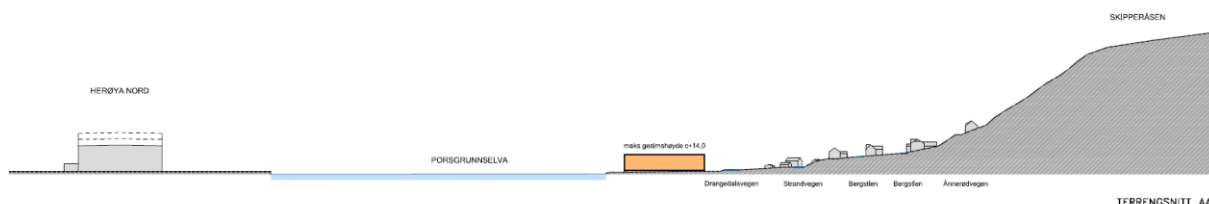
Terrengsnitt Skjærråsen – gjennom planområdet og Porsgrunnelva – bygg på Herøya. Planlagt bebyggelse er vist med orange.
